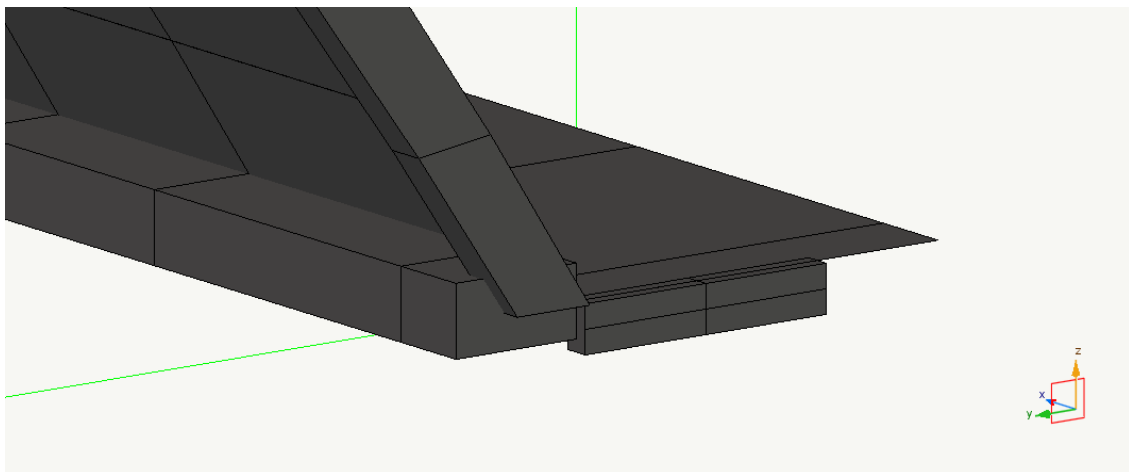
Particolare della trave di collegamento tra i pilastri.
